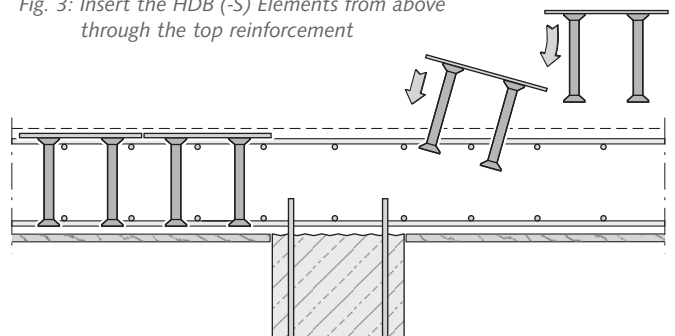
Colocação do pente HDB (-S) sobre a armadura superior da laje
